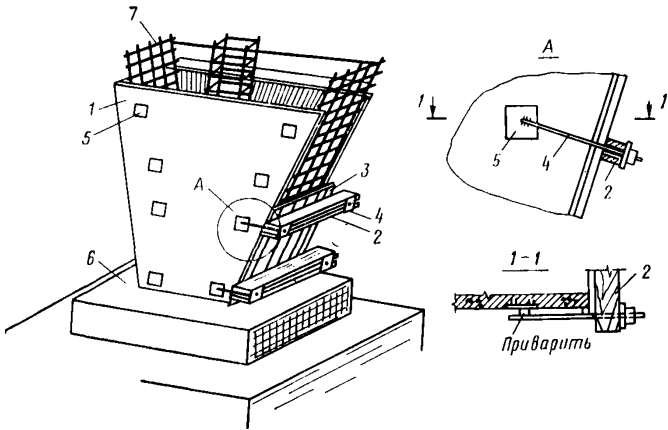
Опалубка сборно-монолитного пилона путепровода
